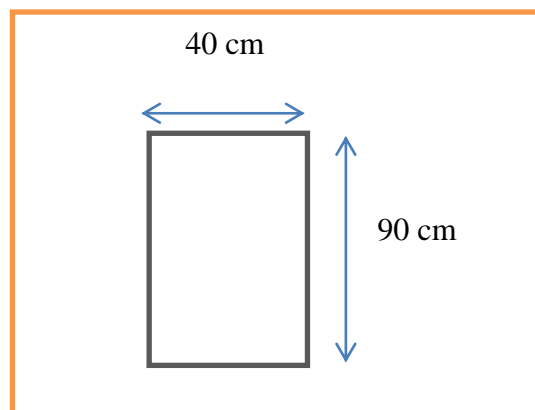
Schéma d'une coupe transversale en travée et en appui.
